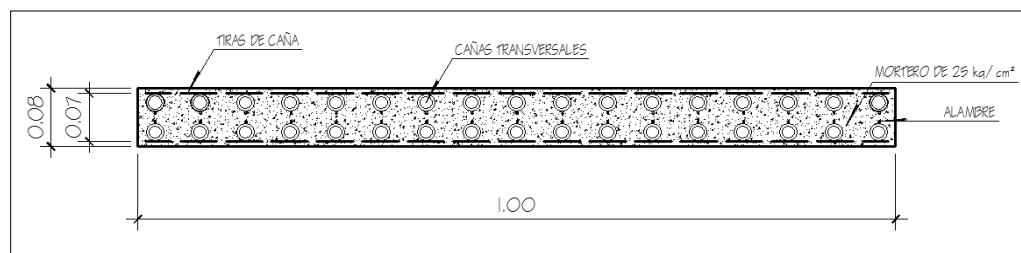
Detalle planta núcleo CeNCa tipo “T”
